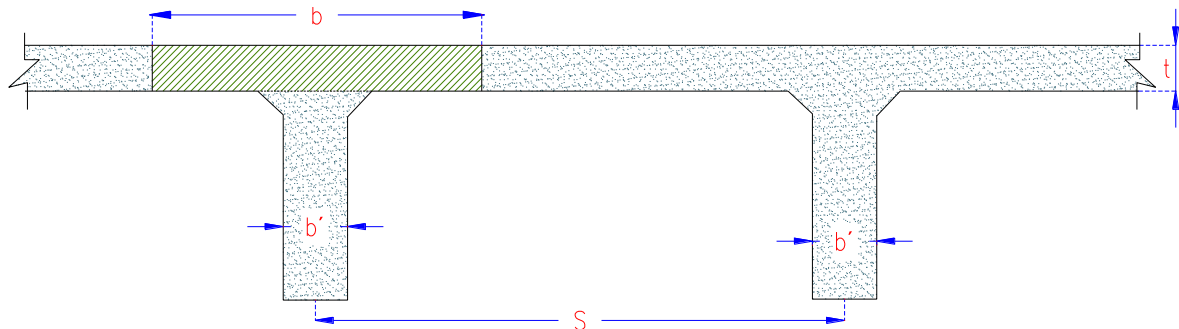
Sección transversal de la superestructura para el dimensionamiento.
